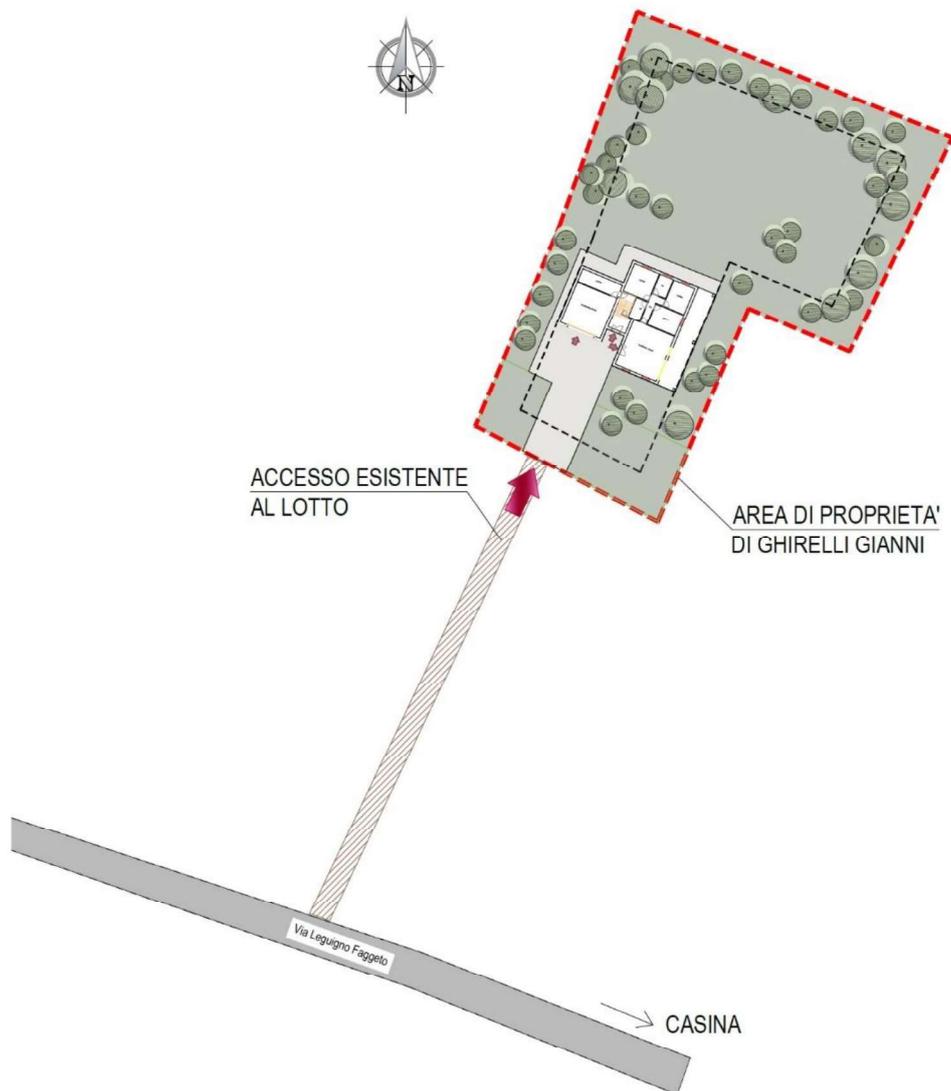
Planimetria generale con sistemazione interna del lotto edificabile (proposta non vincolante)
